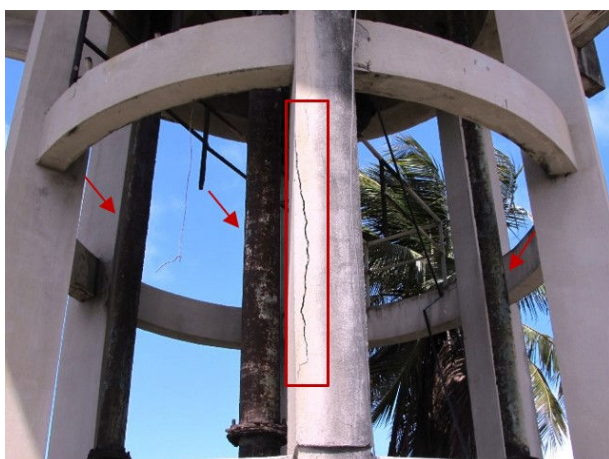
Vista do reservatório (face oeste), em destaque rachadura (retângulo) no pilar no 2º lance e tubulações com corrosão avançada (setas)
